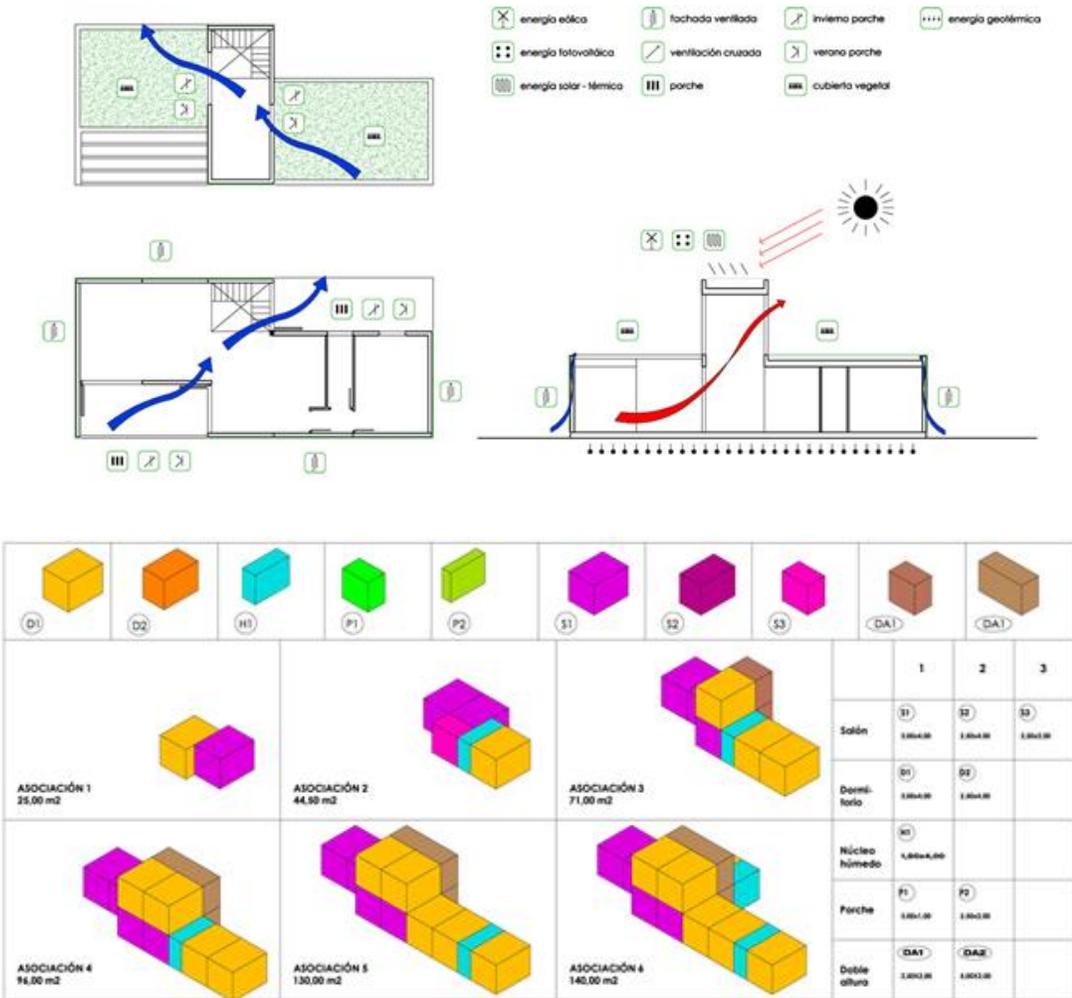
Anexo\_ fotografías\_ Autoría Jesús Rojo
